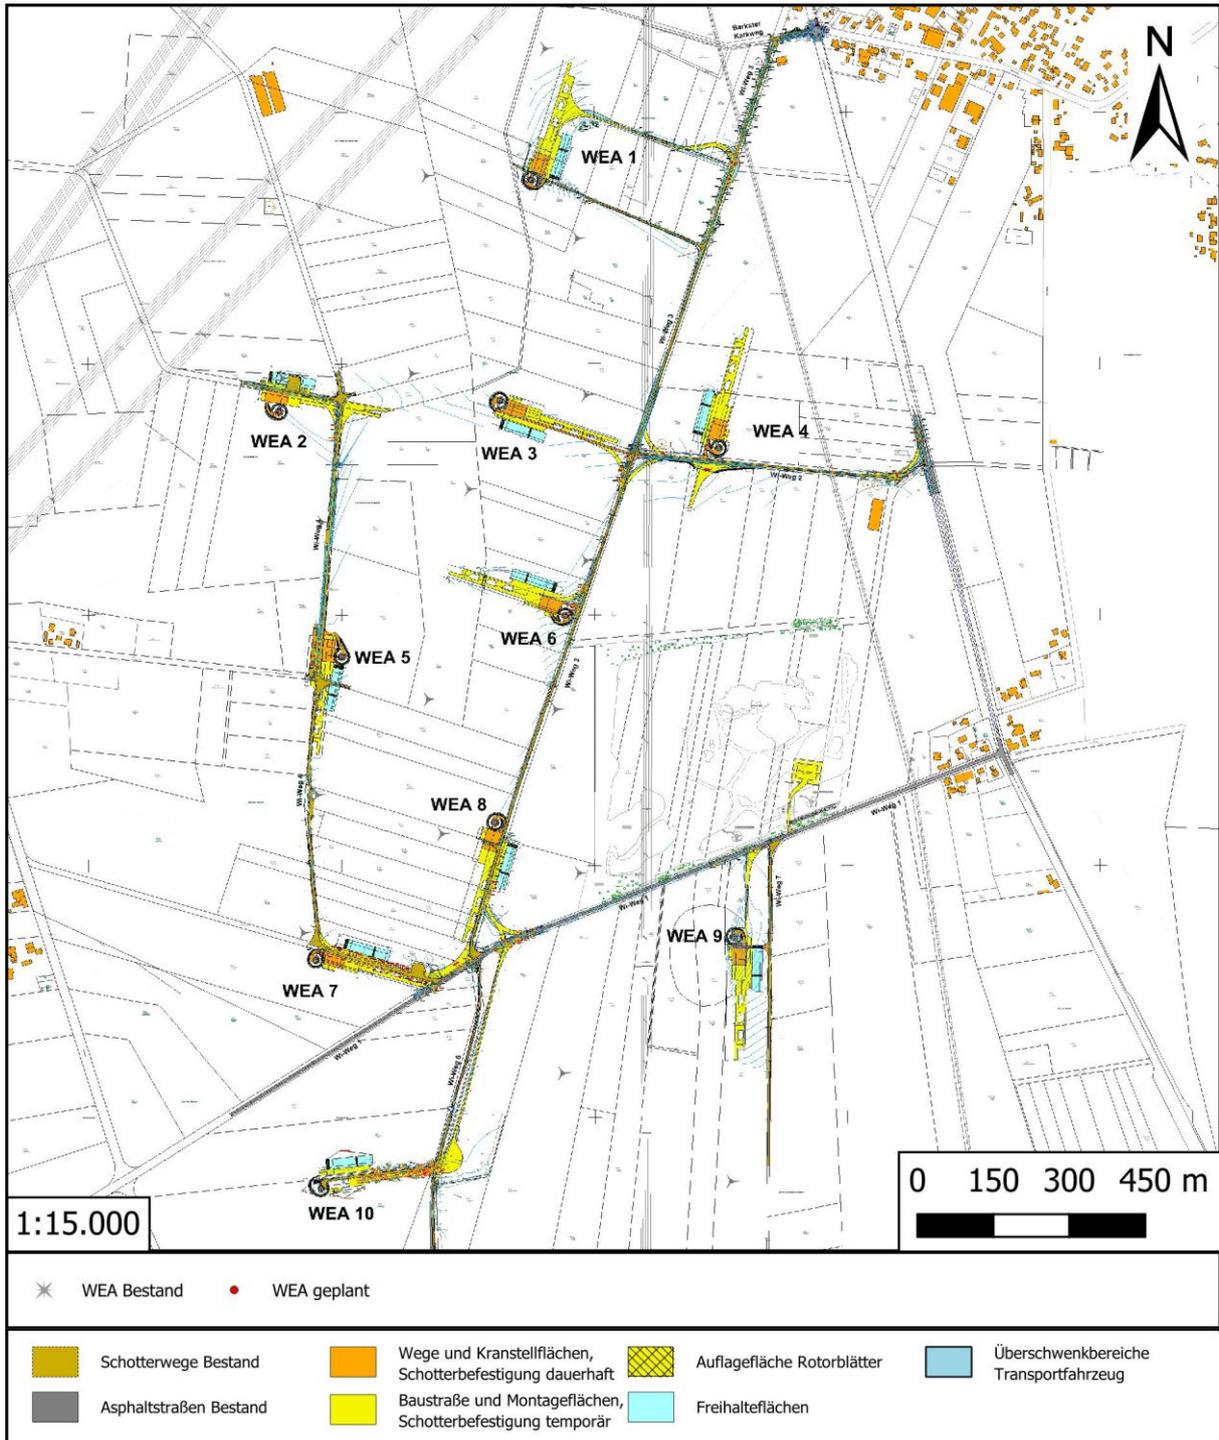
Lageplan der geplanten WEA der Deinste-Helmste Wind GmbH & Co. KG, bereitgestellt durch Kirchner Infrastrukturplanung, 21682 Stade, Stand 16.04.2025). M 1:15.000.
